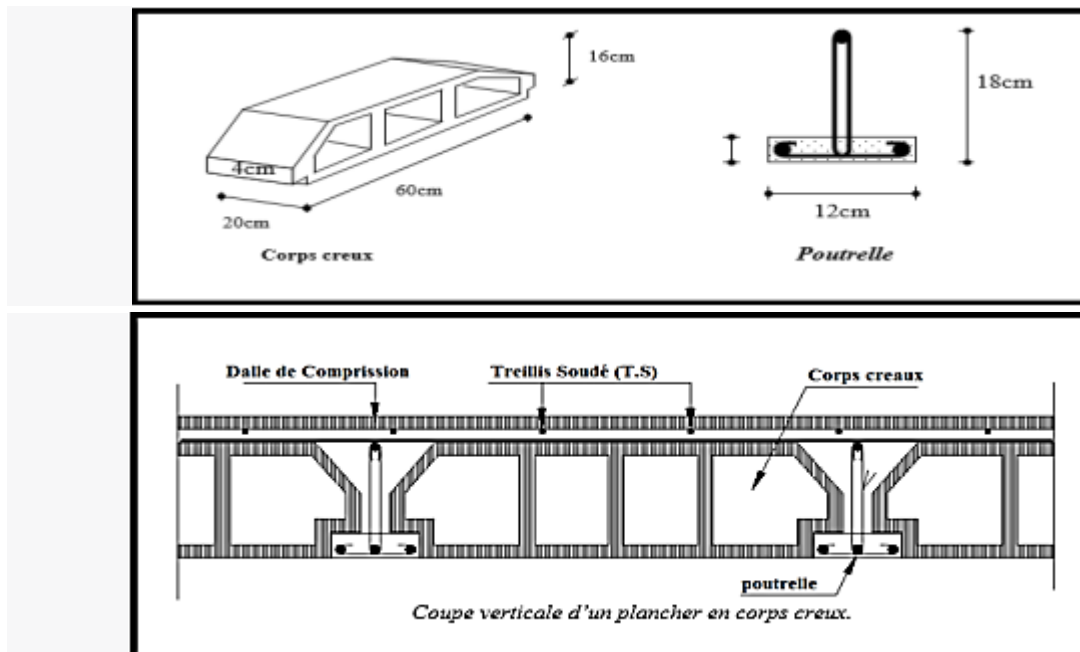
Coupe verticale d'un plancher corps creux.
